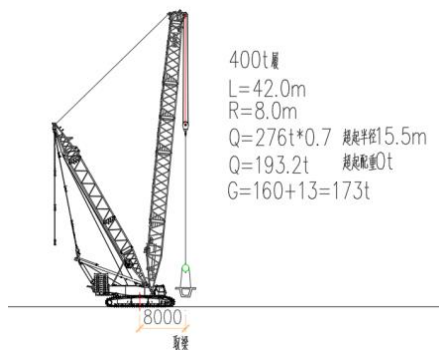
P107-108 小箱梁单机吊装工况 (取梁) 立面图 1
